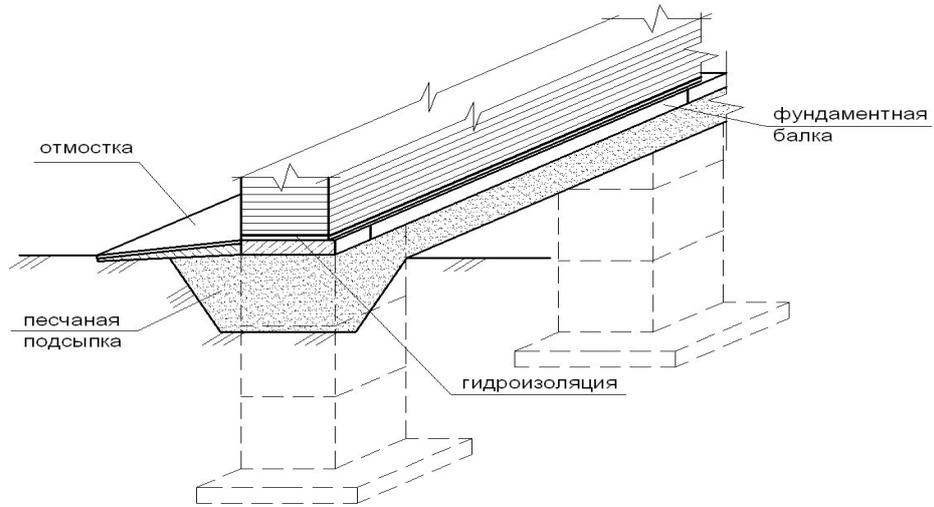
Столбчатые фундаменты малоэтажных зданий под каменные стены.
